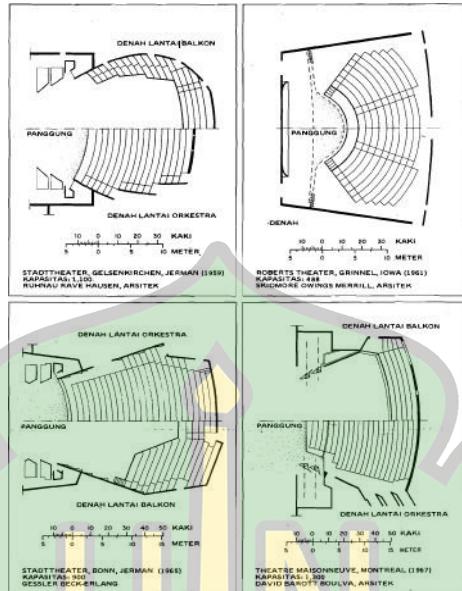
Contoh Denah Lantai bentuk Tapal Kuda
